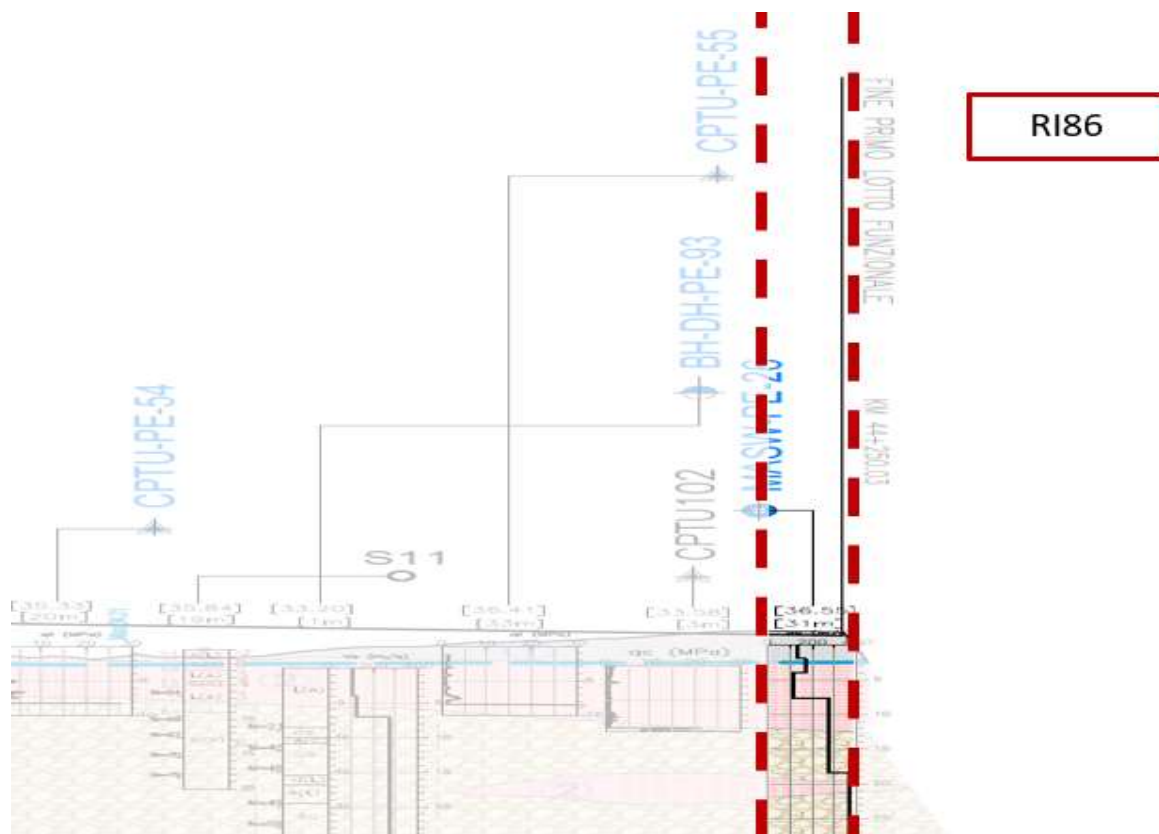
Profilo Geotecnico Rilevato RI86, estratto dal Profilo Geotecnico Generale (Doc. Rif. [3])
